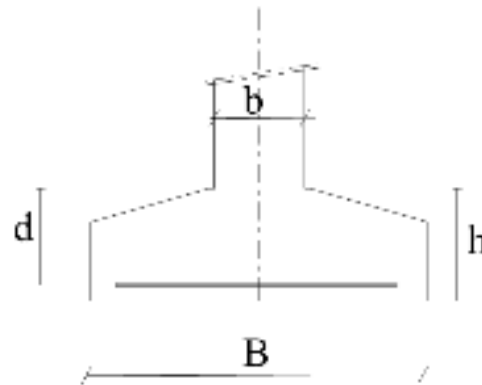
Dimensionnement d'une semelle filante dans le sens y-y.
